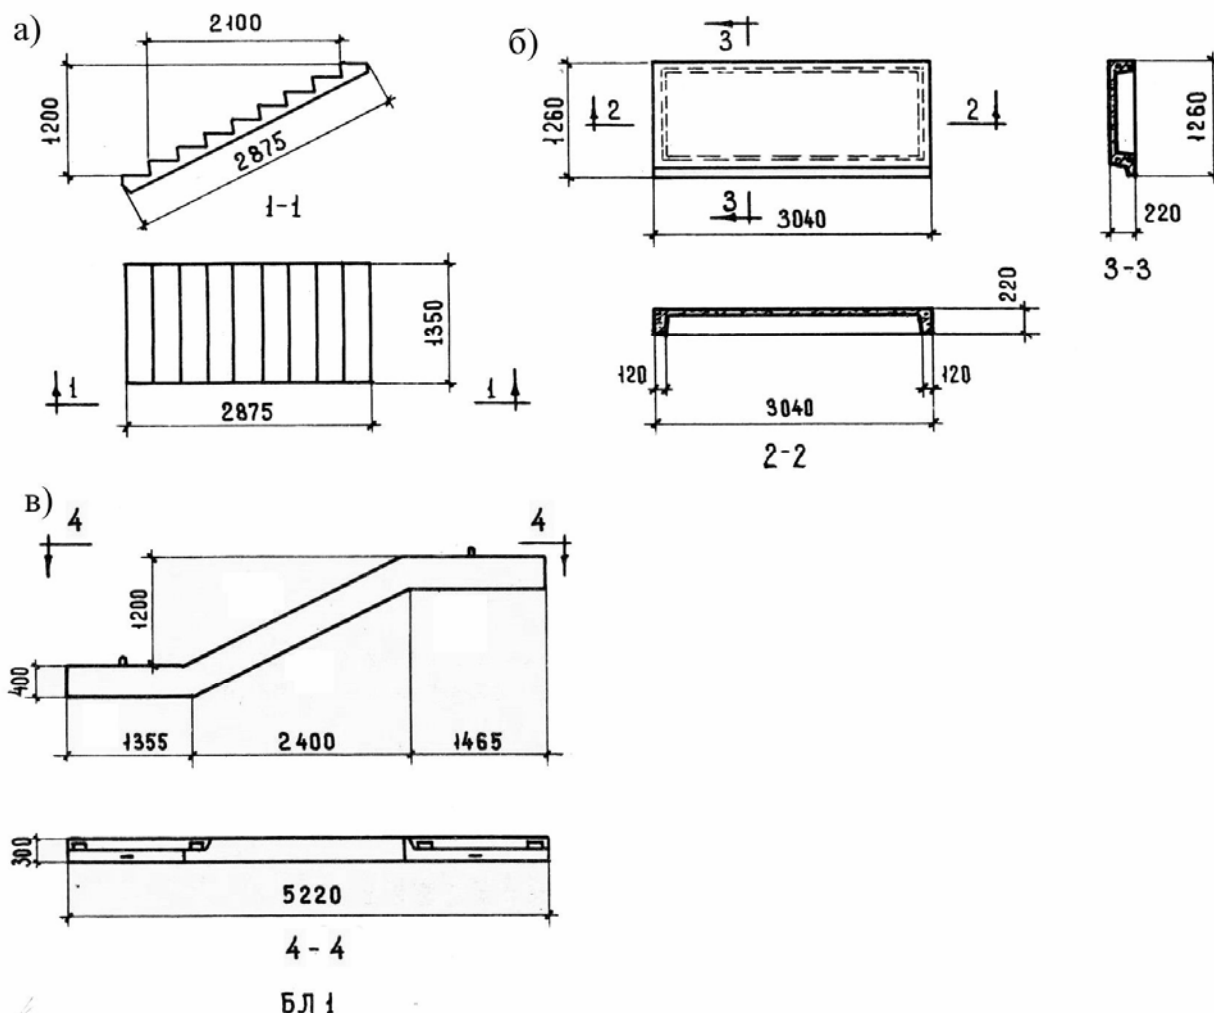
Лестницы многоэтажных зданий из железобетона:
